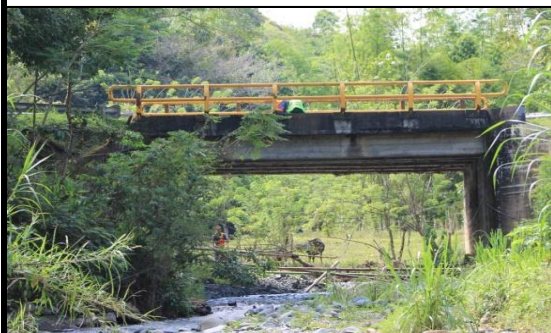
VISTA PANORAMICA LONGITUDINAL
